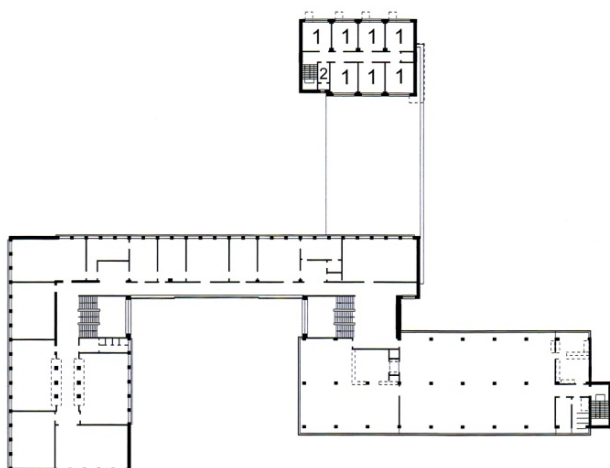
e 36- Planta piso 1 e piso térreo, respectivamente.
